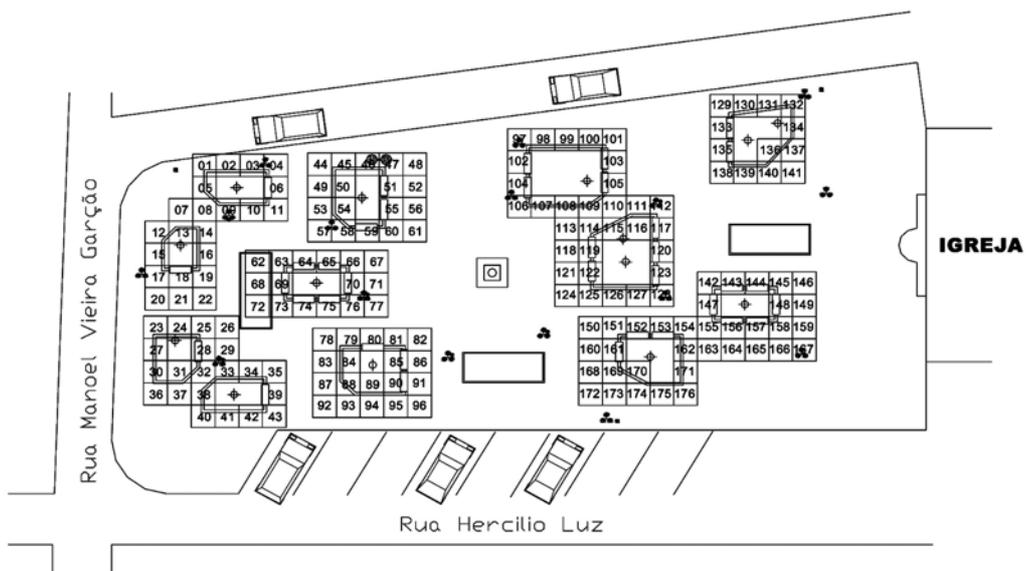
Planta Baixa da Praça Vidal Ramos, com a malha numerada
